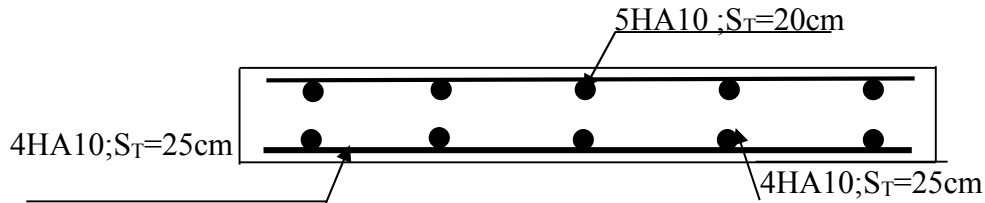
Schéma de ferrailage de la dalle sur quatre appuis.
